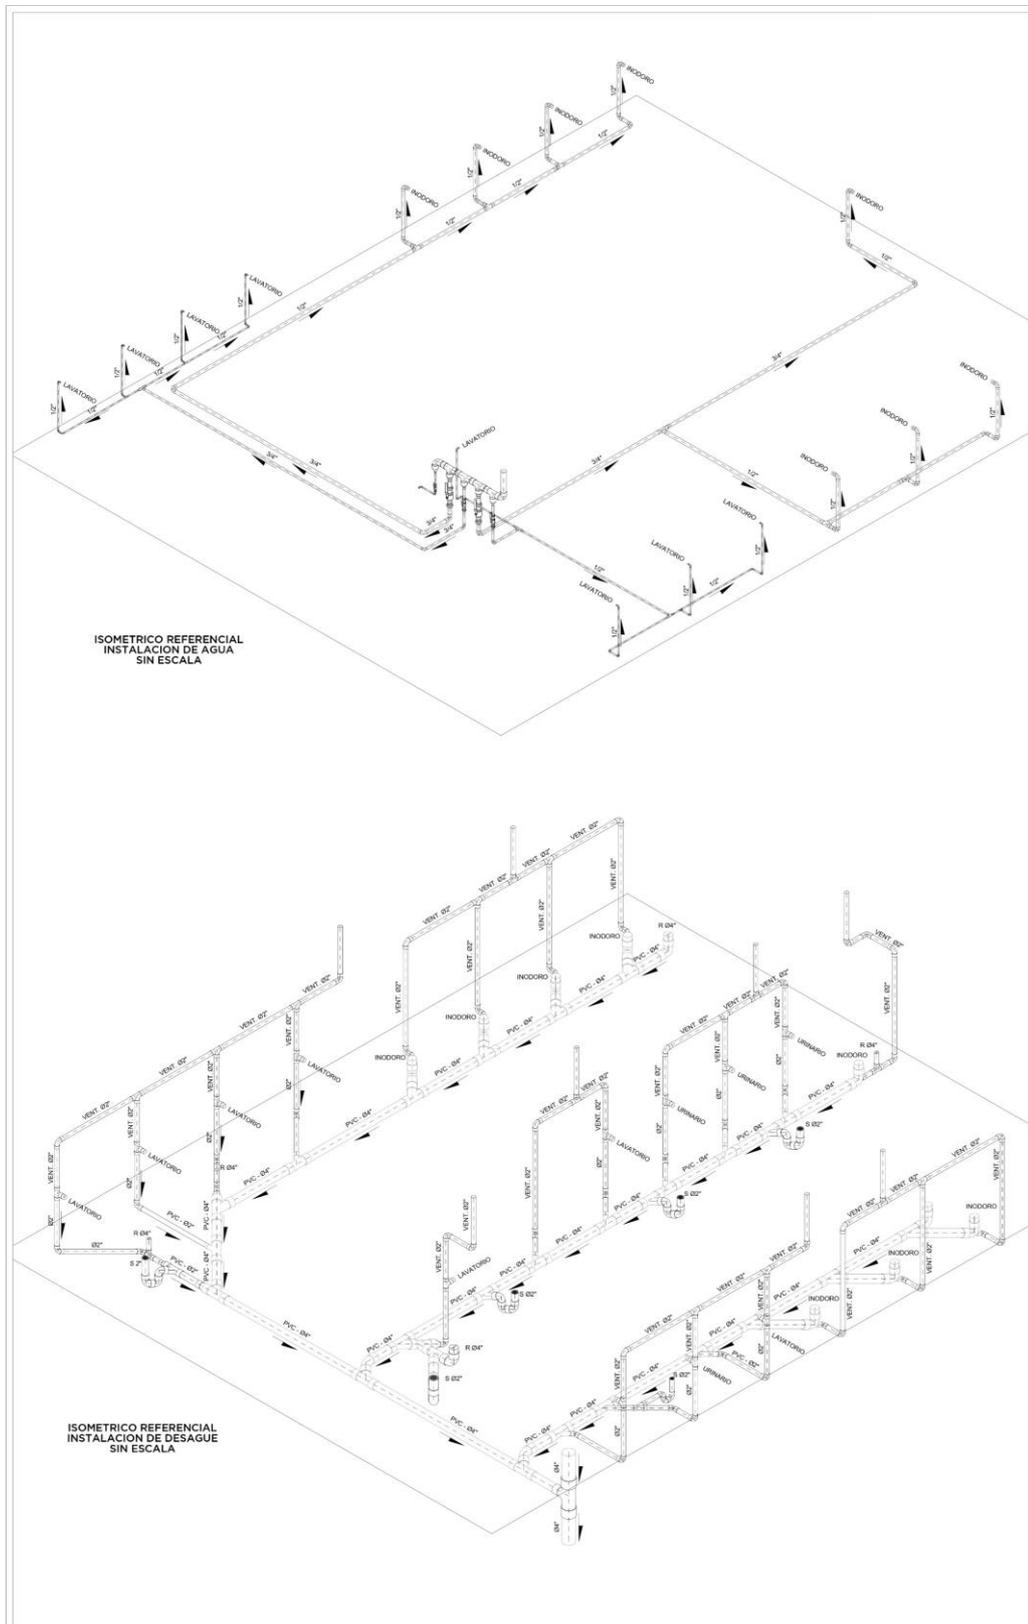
Planta especialidad sanitarias – Isometrías
